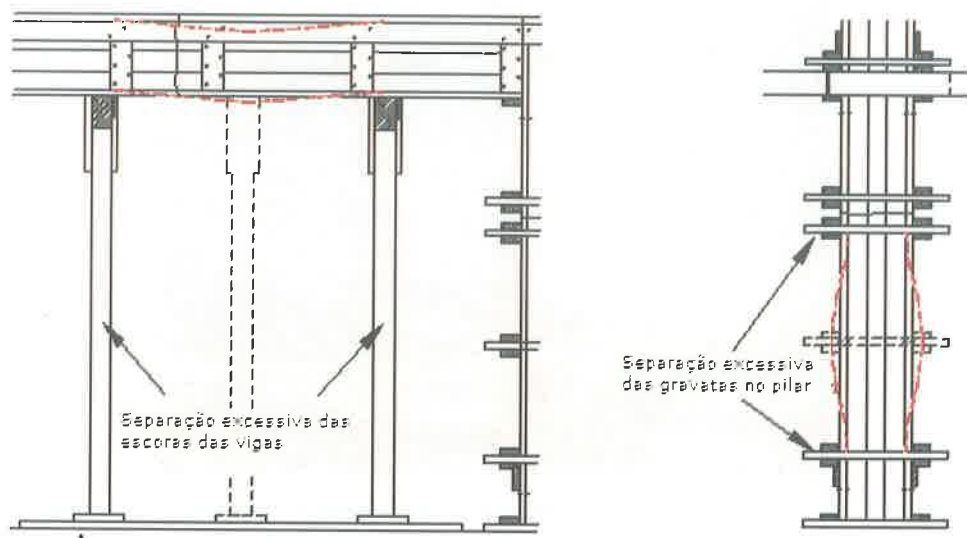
Falhas por projeto inadequado de sistema de fôrmas
